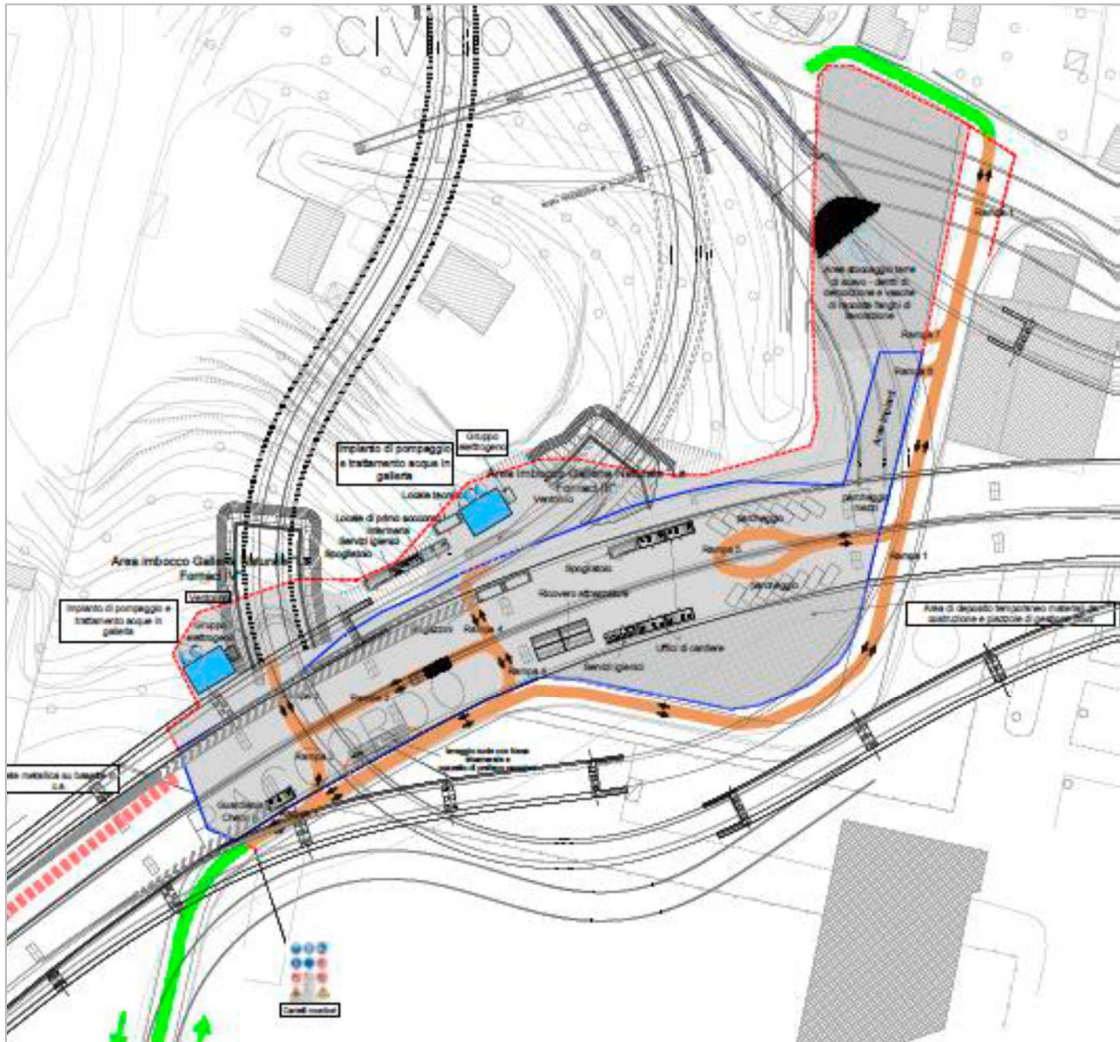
Elaborazione grafica Cantiere Melara– Area di cantiere
